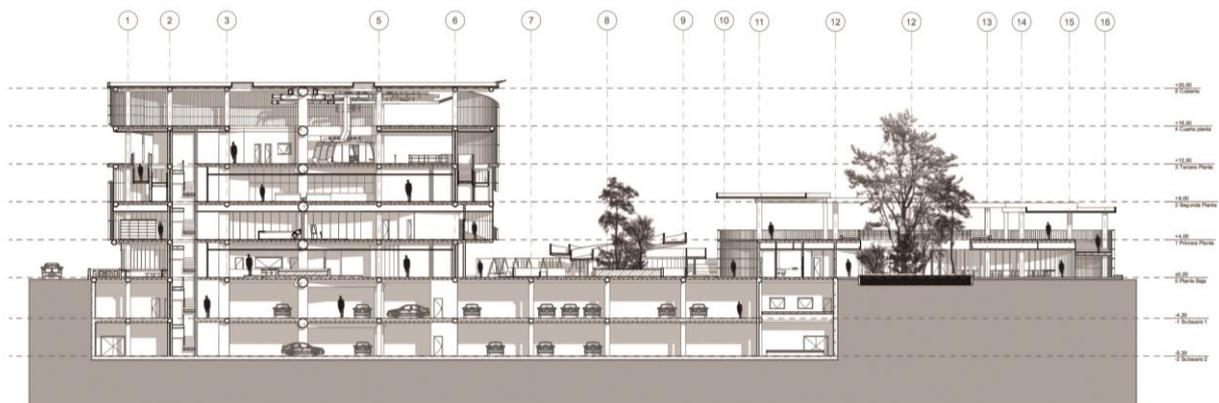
Corte longitudinal B-B'. Elaboración propia.
